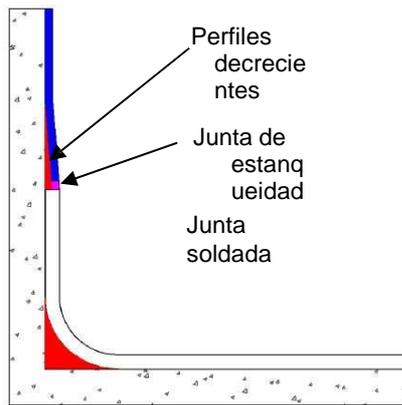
Montante de suelo de PVC: soldadura/junta con perfil decreciente o relleno
